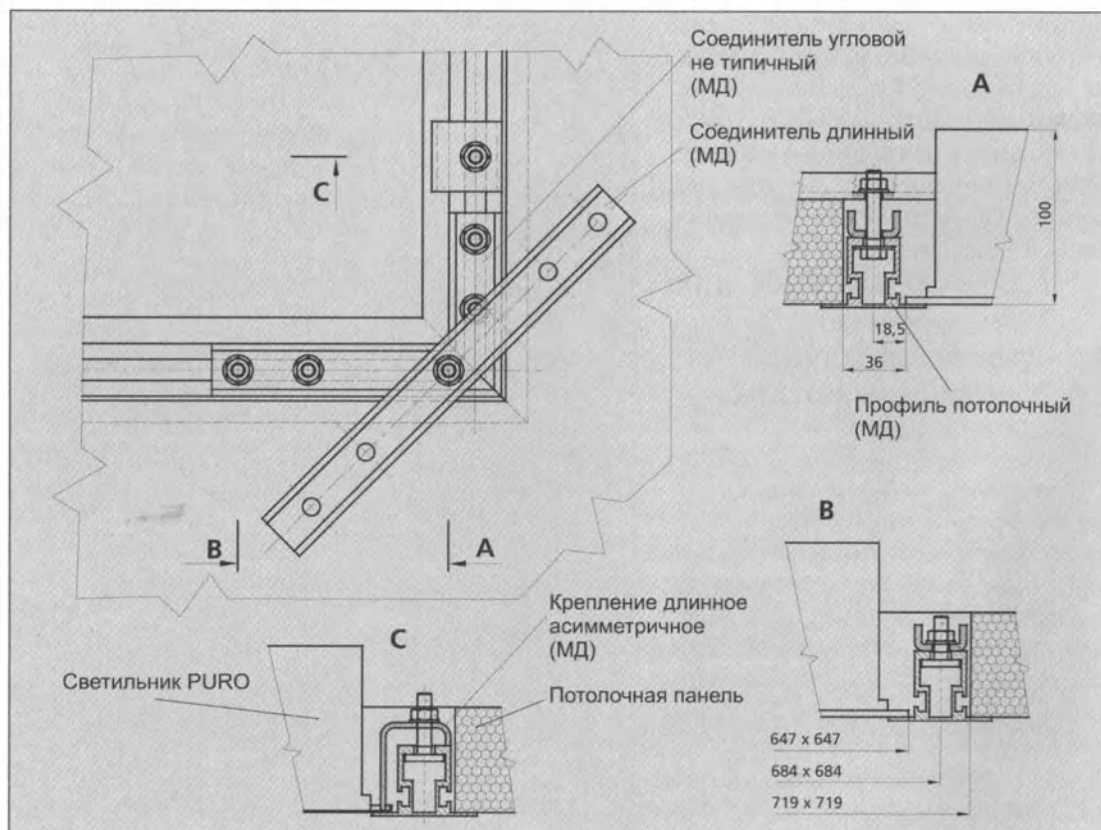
Крепление светильников на панельный потолок с помощью монтажных деталей
